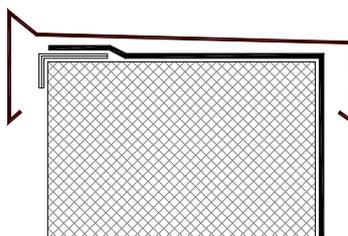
Dachrandabschluss mit Mauerabdeckprofilen
